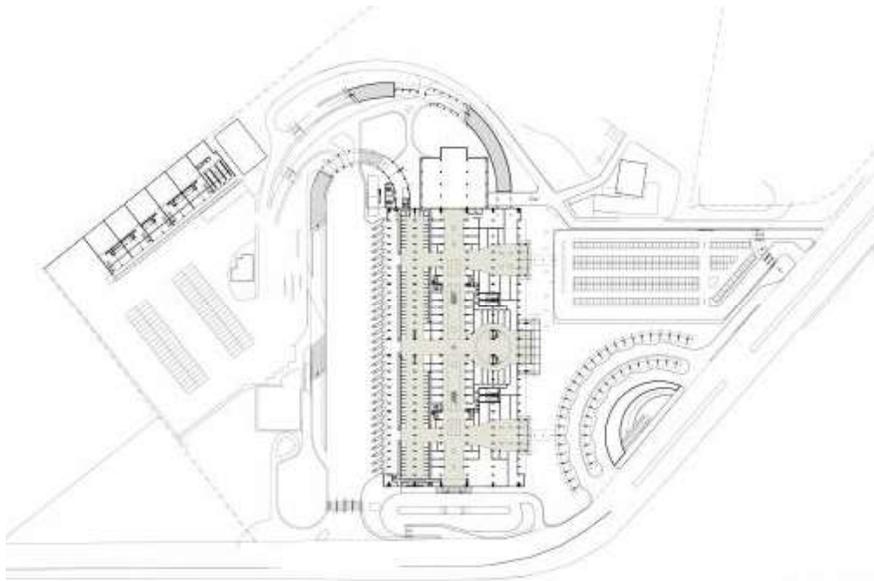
Plano general-Terminal Terrestre de Guayaquil
